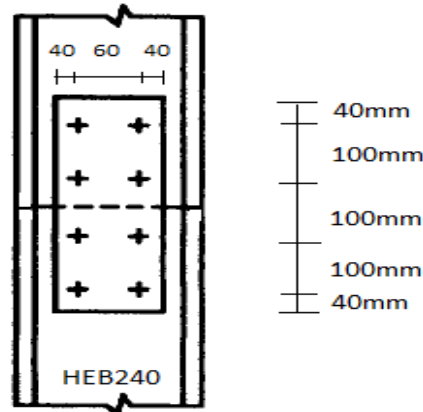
Assemblage poteau- poteau (couvre-joint de l'âme)
